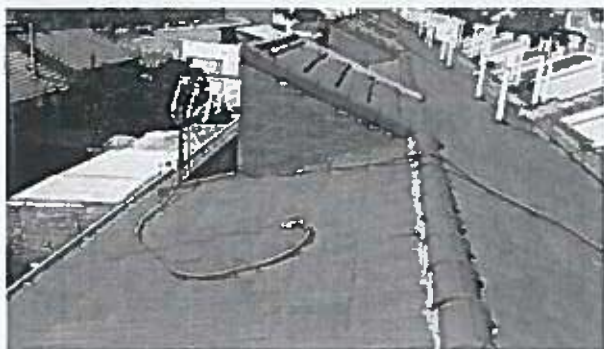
Riego localizado en perímetro de solución constructiva de encuentro cubierta-fachada
